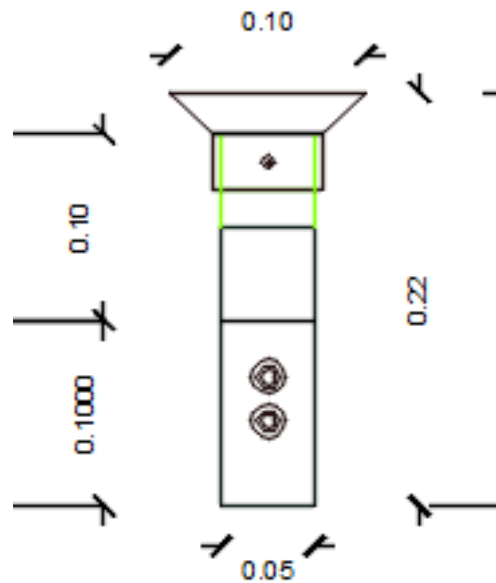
Elaboración propia, Perfil detalle de anclaje en bambú
